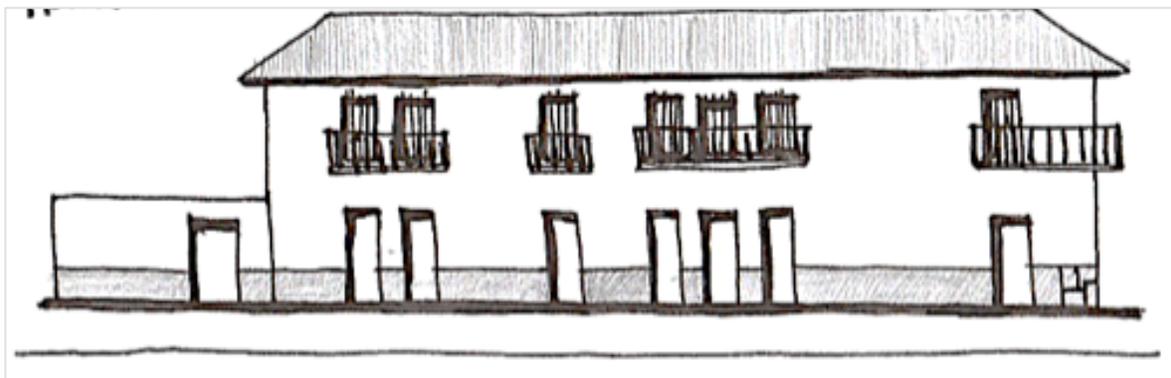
Esquema de Fachada Oeste. Inicial Casa Rivas. Primer estado Colonial. MGC
